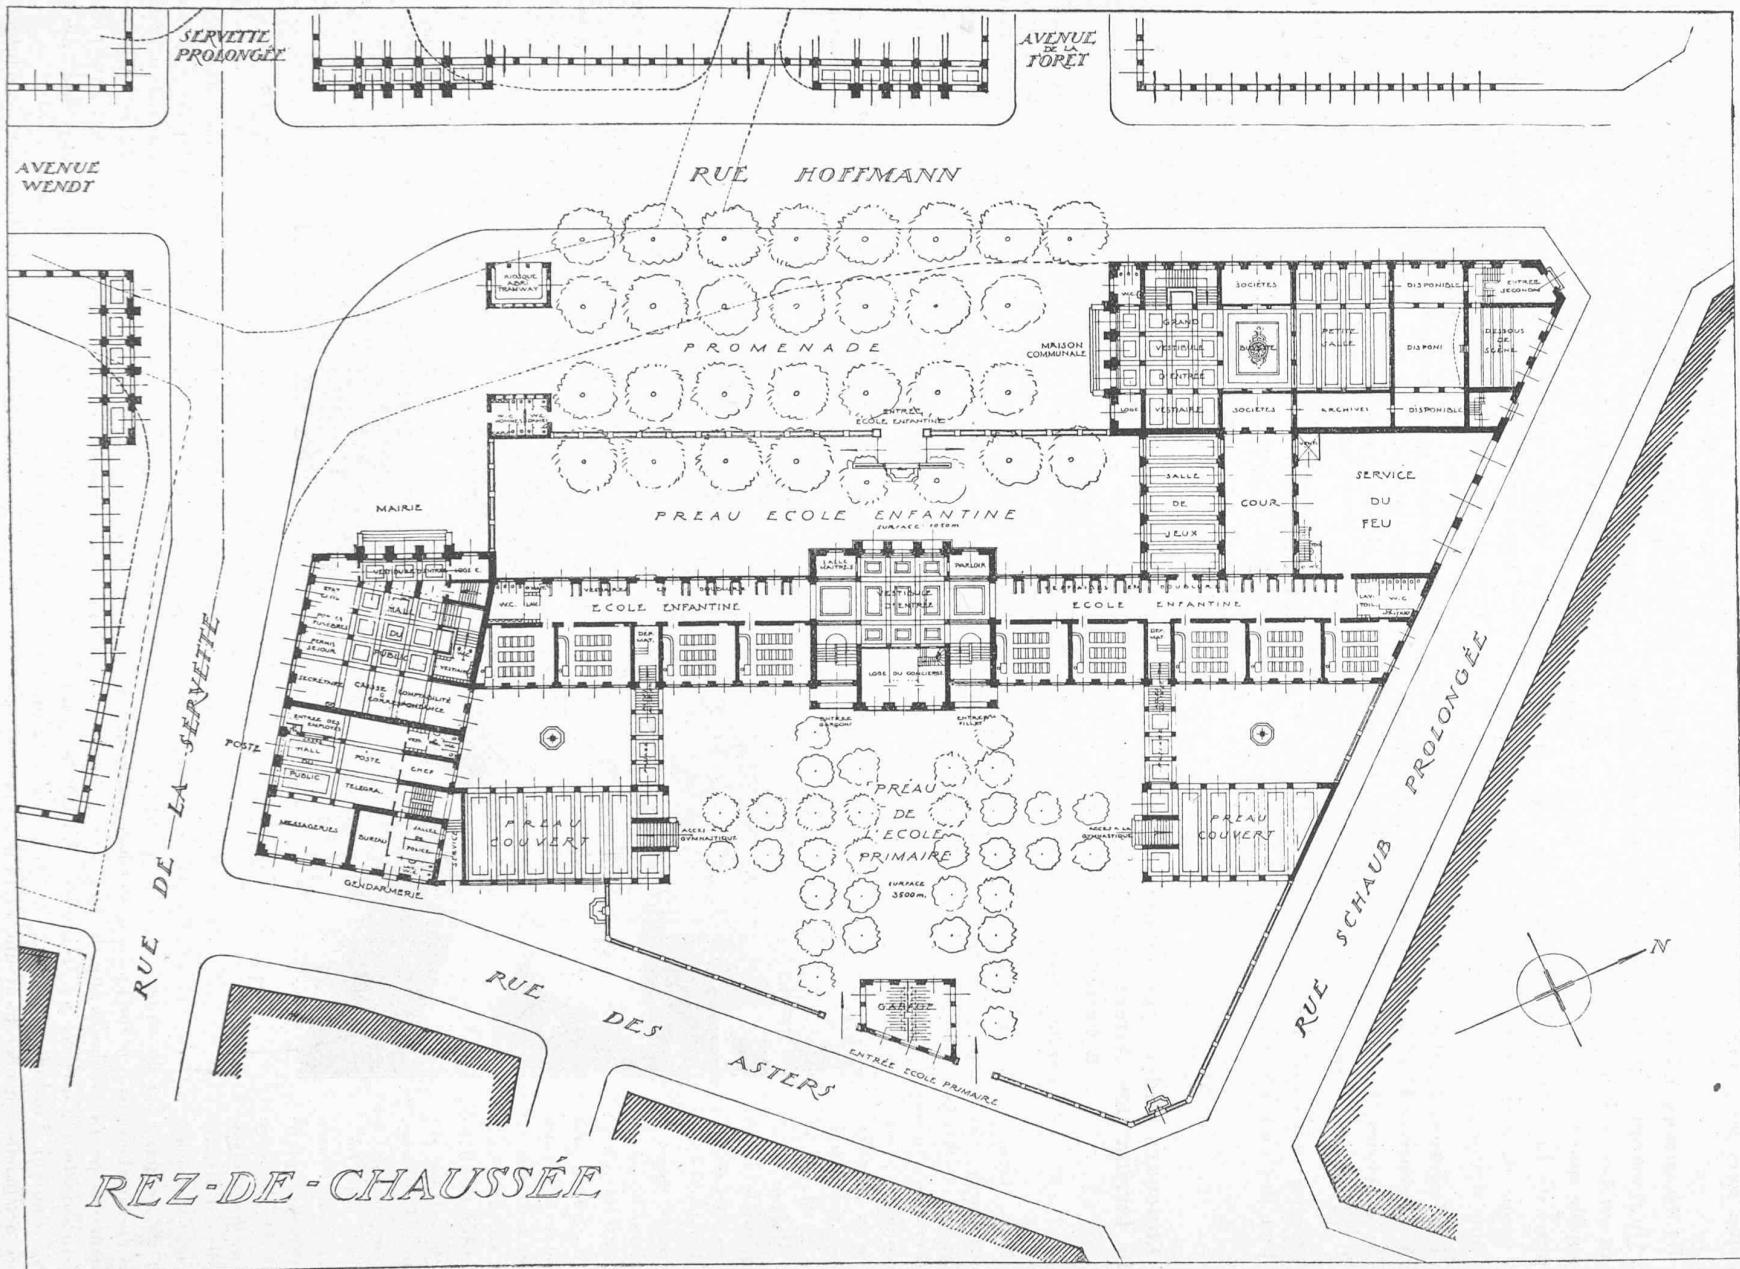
Plan général et rez-de-chaussée. — 1:800.
